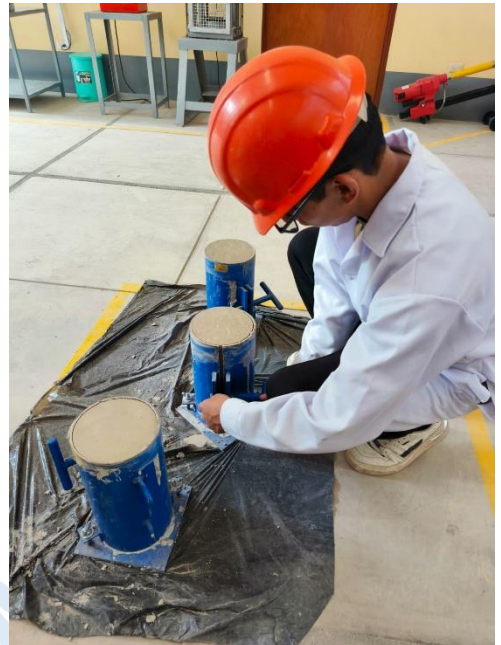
Transcurrida las 24 horas se extraen las probetas
